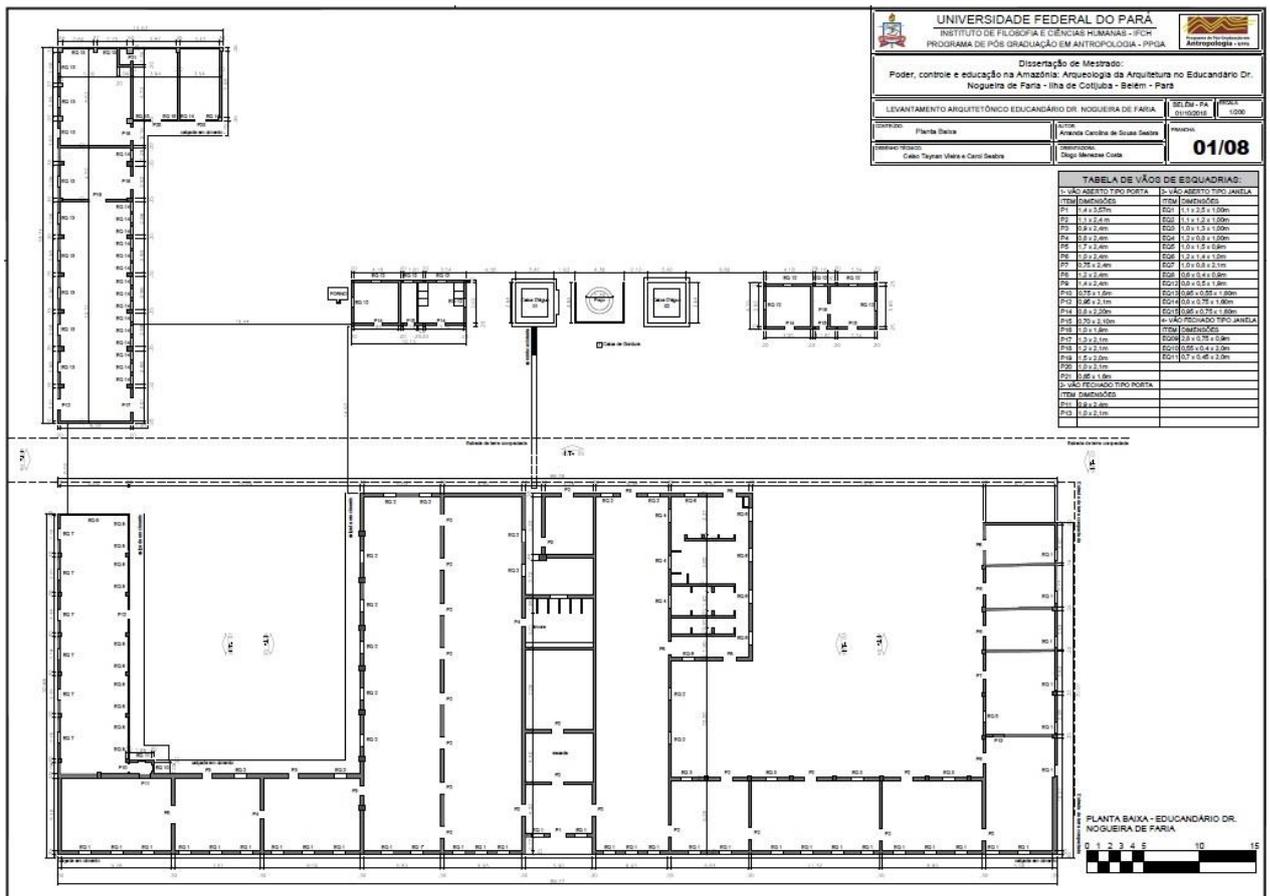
Planta baixa do Educandário Dr. Nogueira de Faria com as medidas.²⁶
